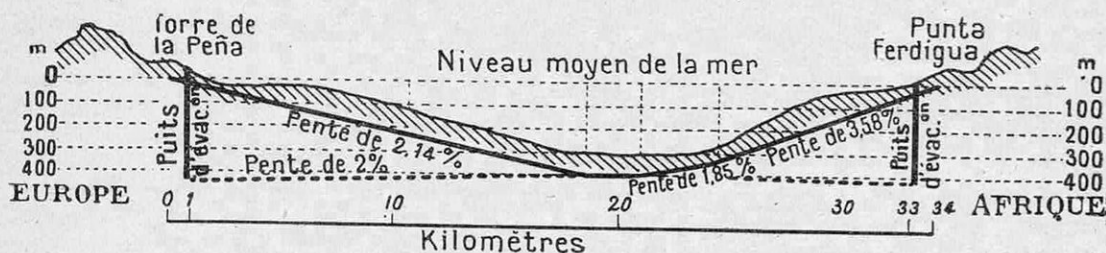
COUPE LONGITUDINALE DU TUNNEL DE GIBRALTAR (PROJET JEVENOIS)
